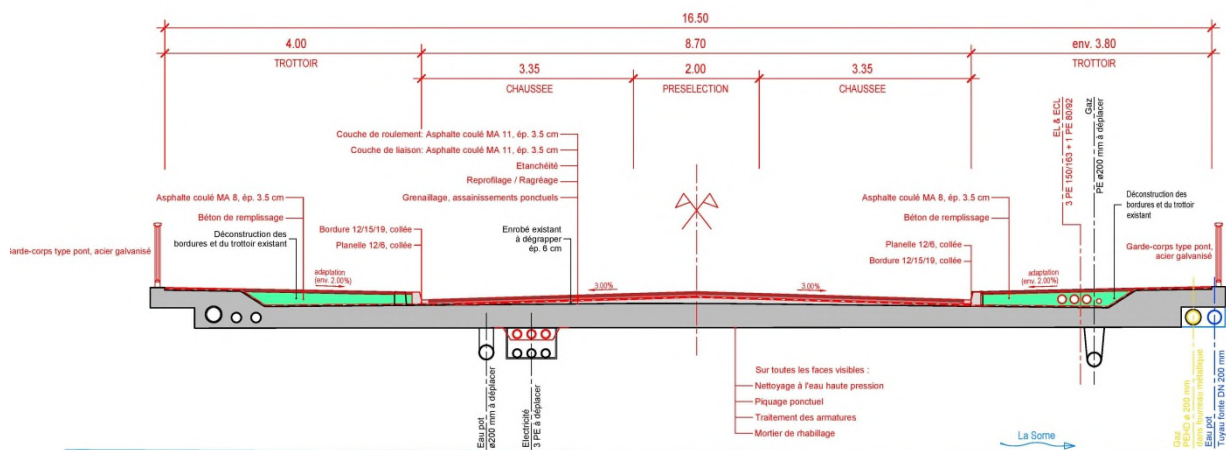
assainissement du pont de la rue de l'Avenir – coupe-type
